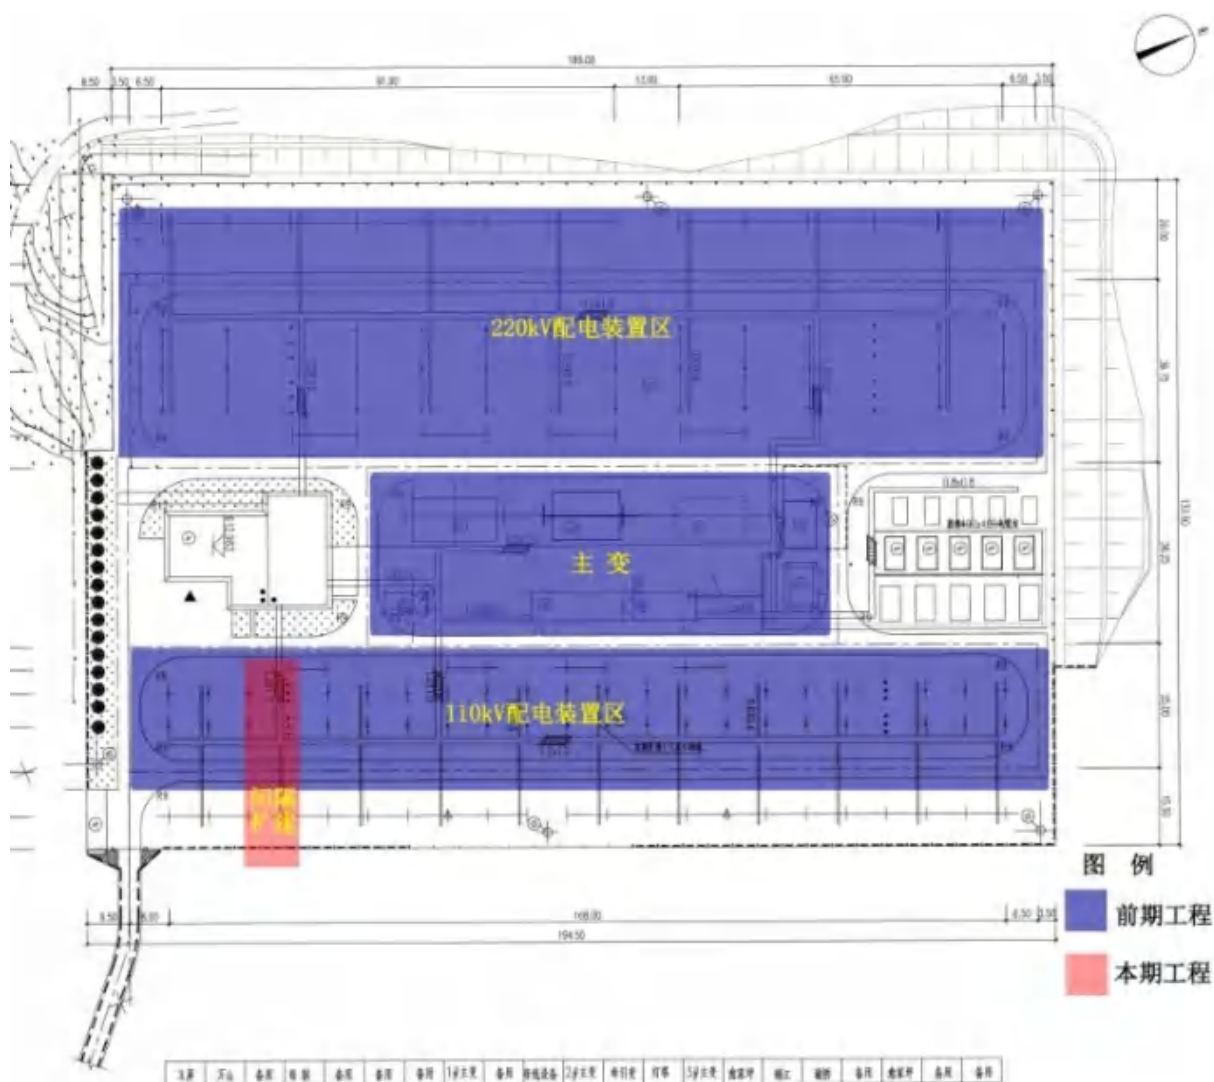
开天 220kV 变电站扩建总平面布置图
